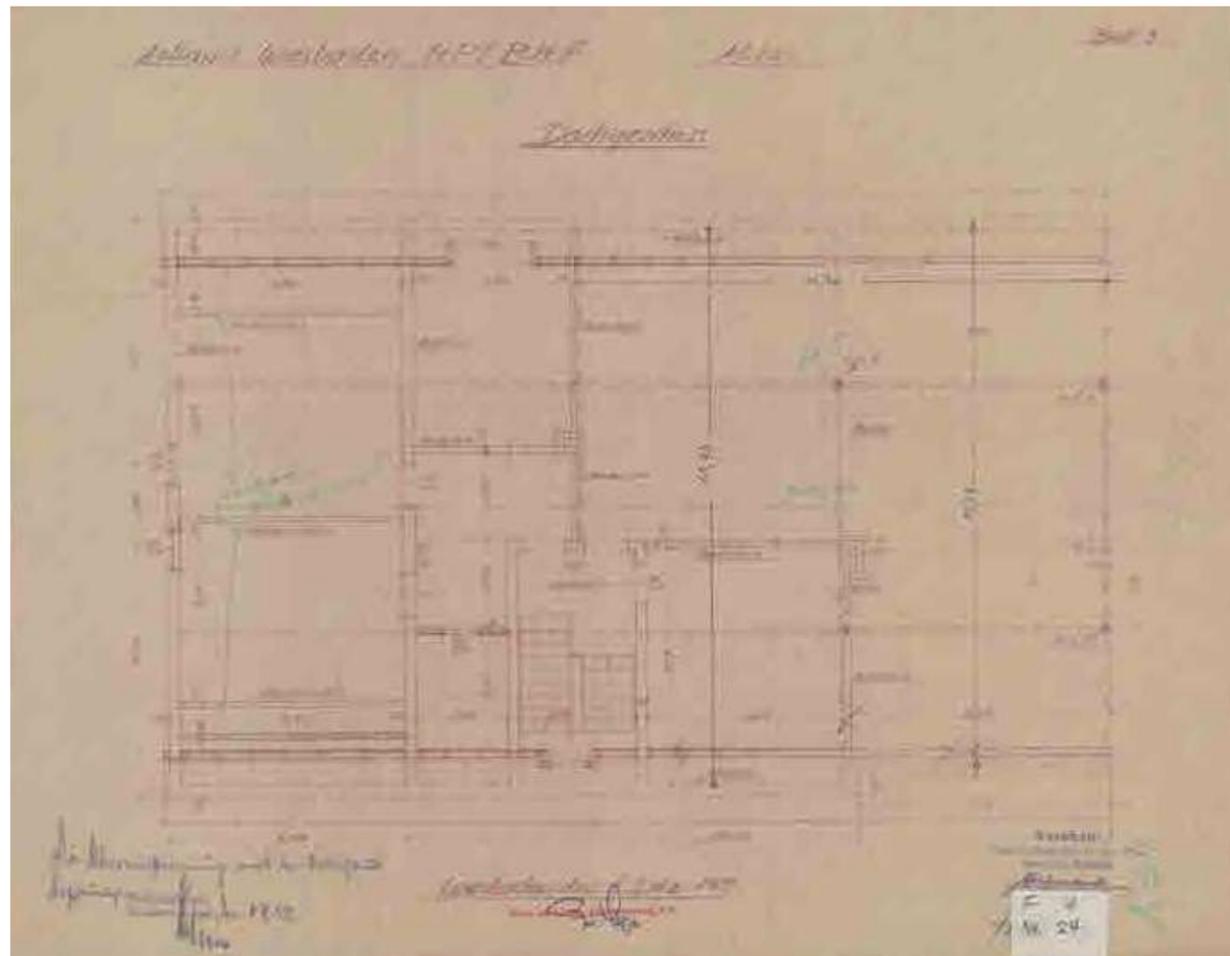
Zollabfertigung: Plan mit Grundriss des Dachgeschosses für den Wiederaufbau, 1951
